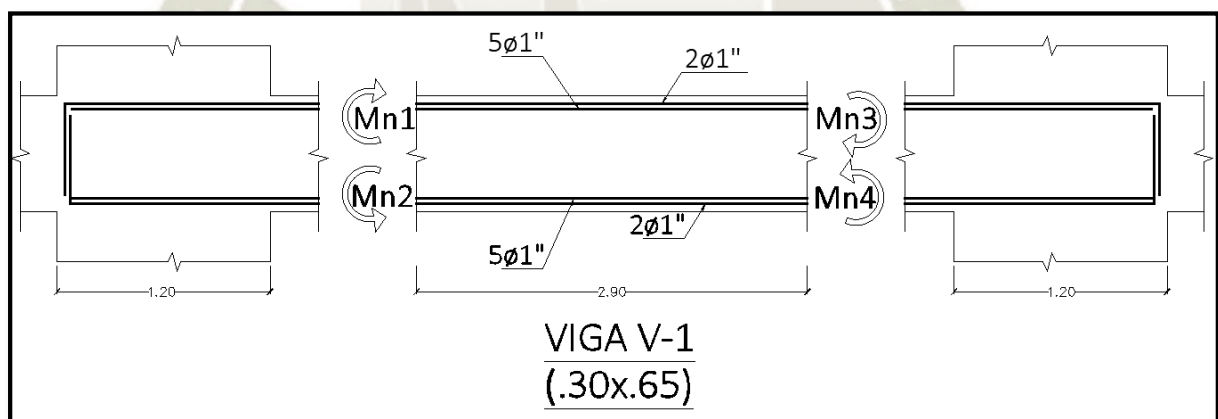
Armado de acero longitudinal de viga V-1 (Fuente: Elaboración propia)
